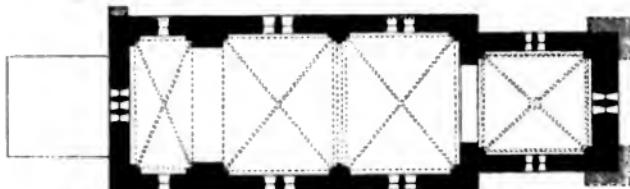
Grundriss der Kirche. 1:100.
